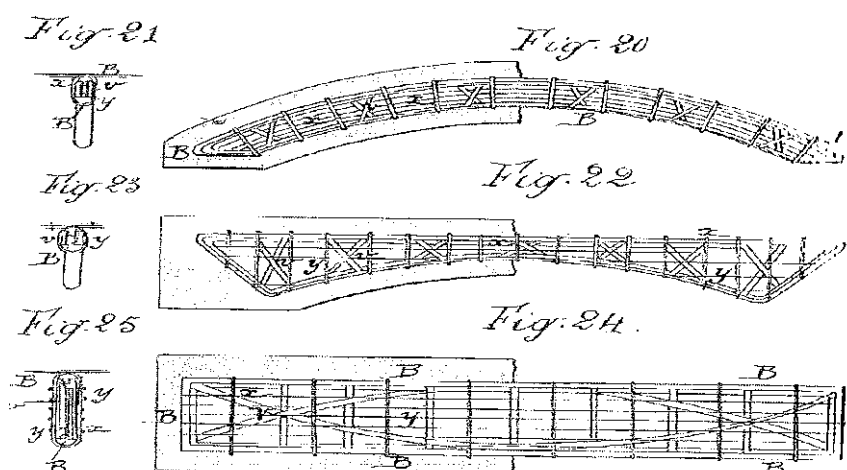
Vigas y viguetas para puentes. Patente española Monier.
